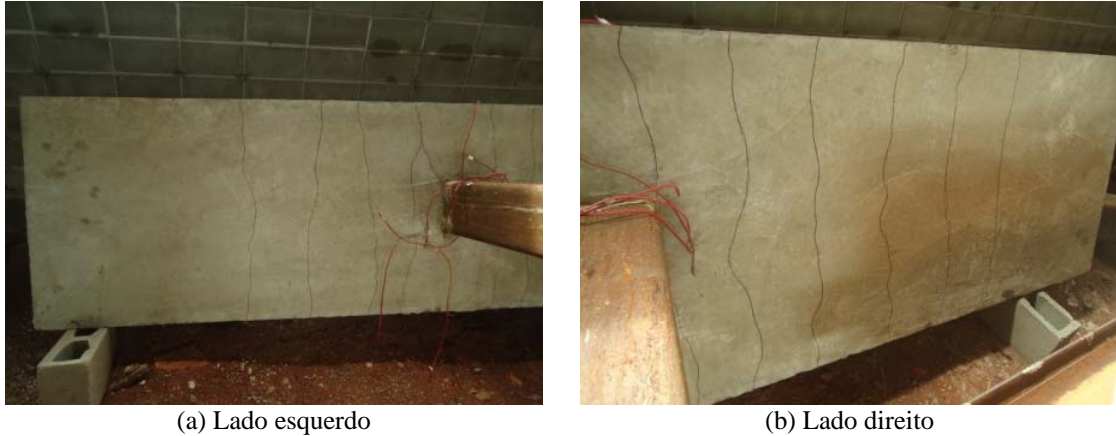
Fissuração na laje do Modelo 3.
